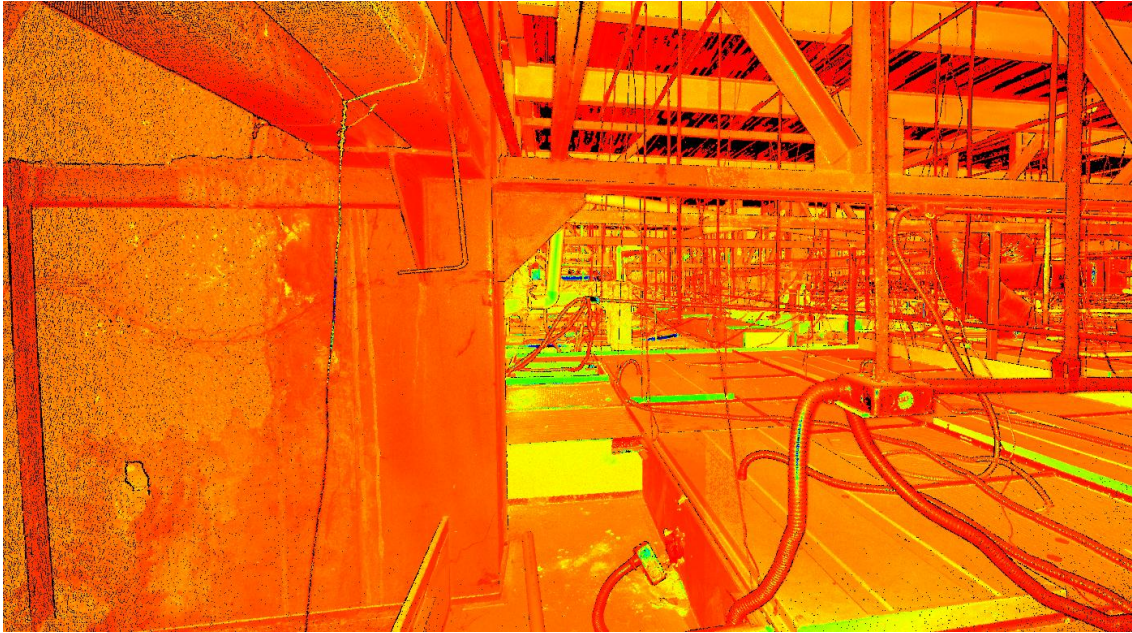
Levantamiento con nube de puntos para planta de fabricación de papel
